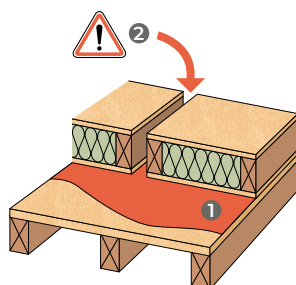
Point de vigilance « étanchéité à l'air entre panneaux »
